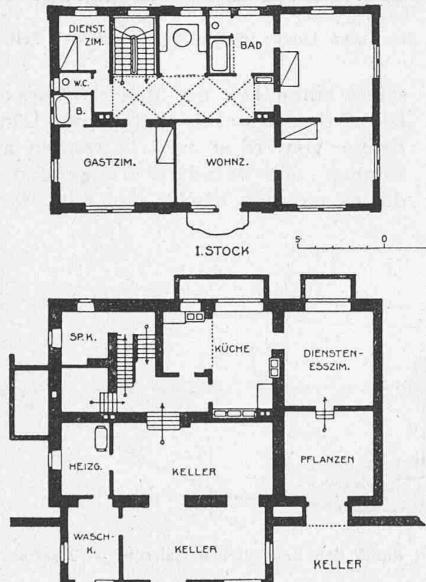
bis 7. Grundrisse des umgebauten „Schlössli“ in Zollikon. — 1 : 400.
